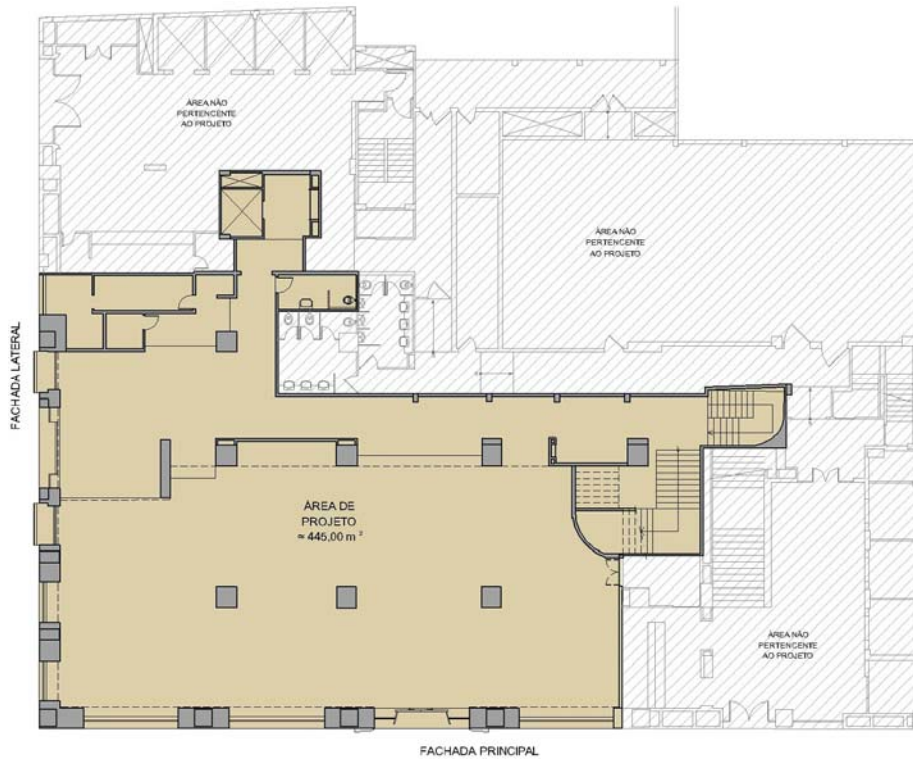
Planta baixa pavimento térreo (limites da área de projeto)
